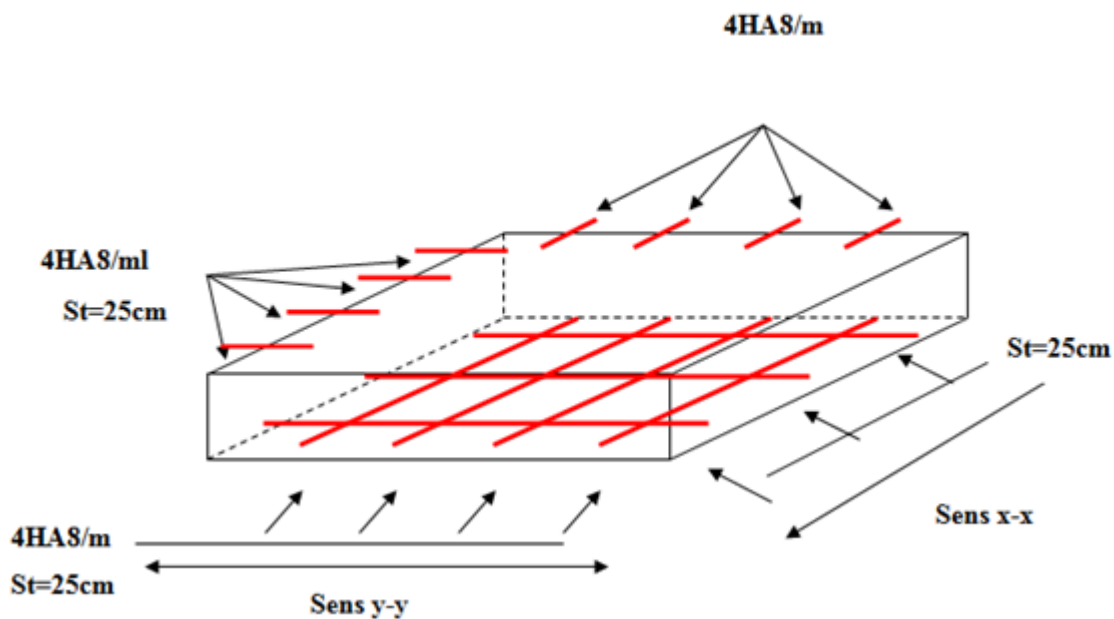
Schéma de ferrailage de la dalle plane de locale machine.
